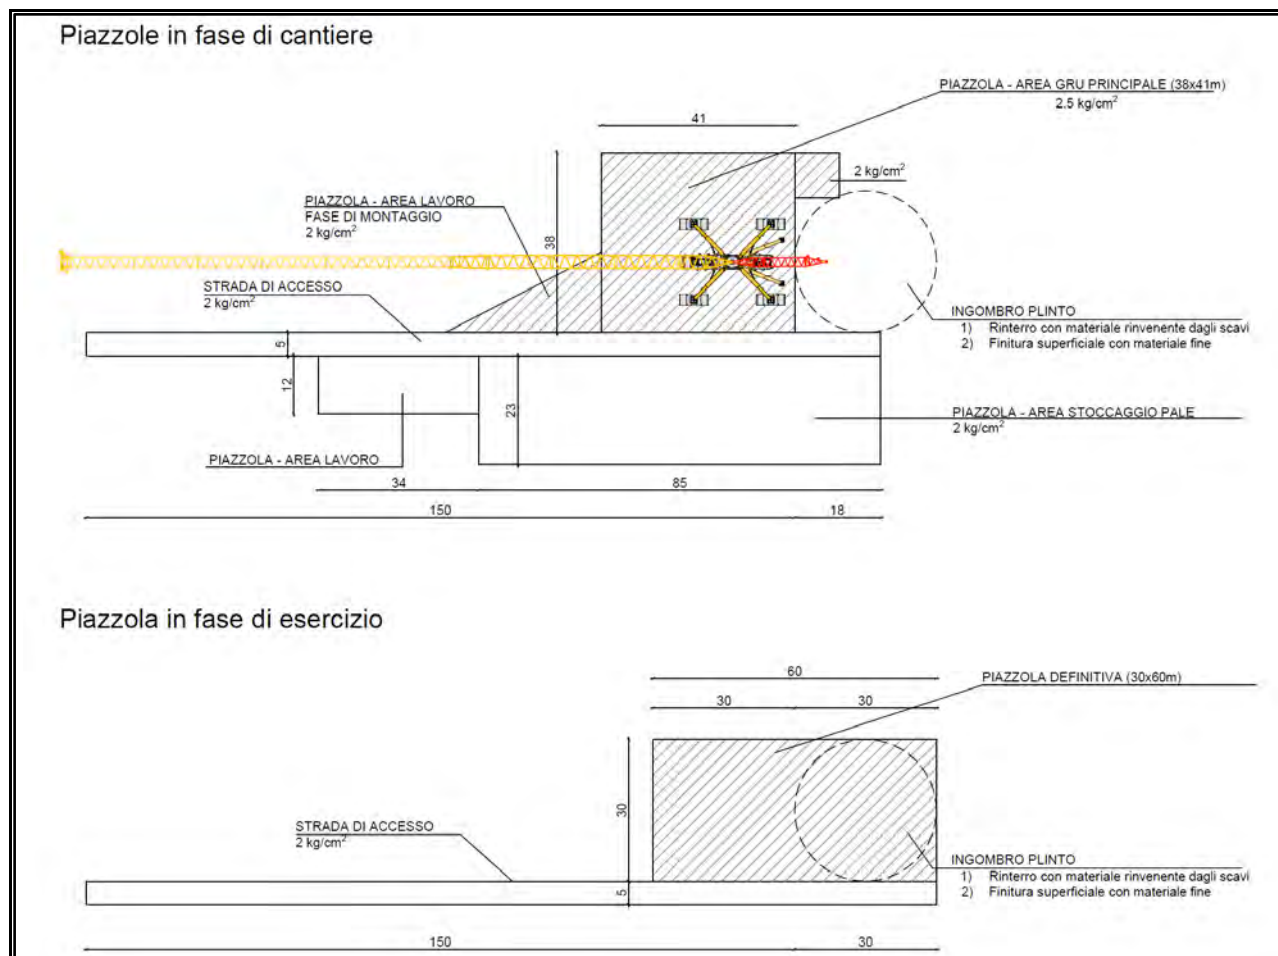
Planimetria piazzola tipo per la fase di installazione e fase di esercizio e manutenzione
